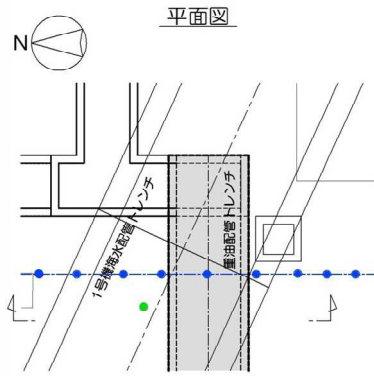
【12-10】1号機取水電源ケーブル管路 施工方法（貫通施工）
